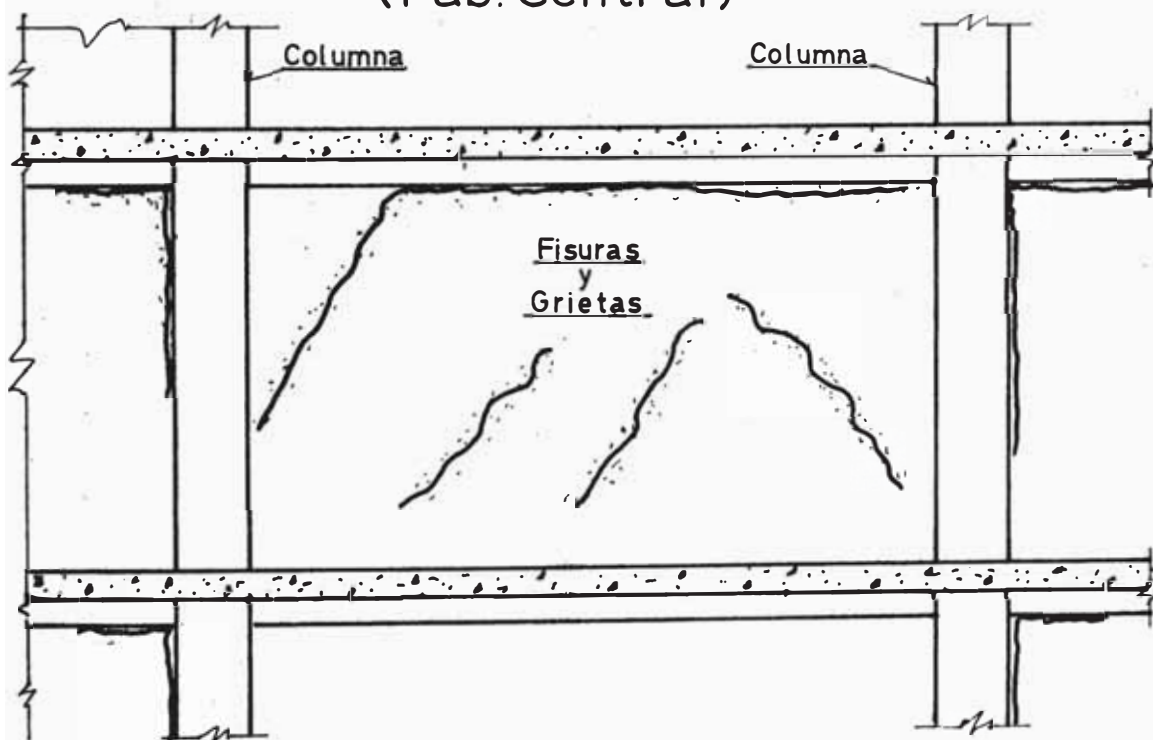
Fisuras y grietas en tabique existente entre los ejes 15 y 16- Direc. secundaria- Corte típico de traccion y compresion diagonal.- Pab. Central- 2º Piso.
